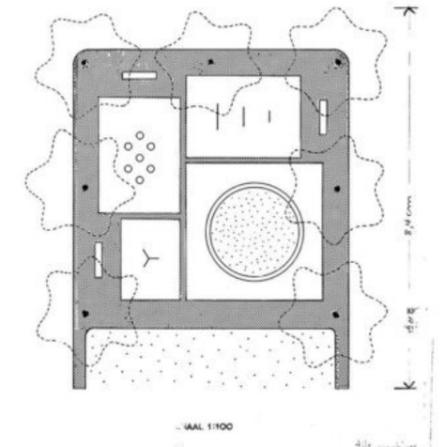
Plano de playground Zaanhof. Fuente: Archivos Ámsterdam
